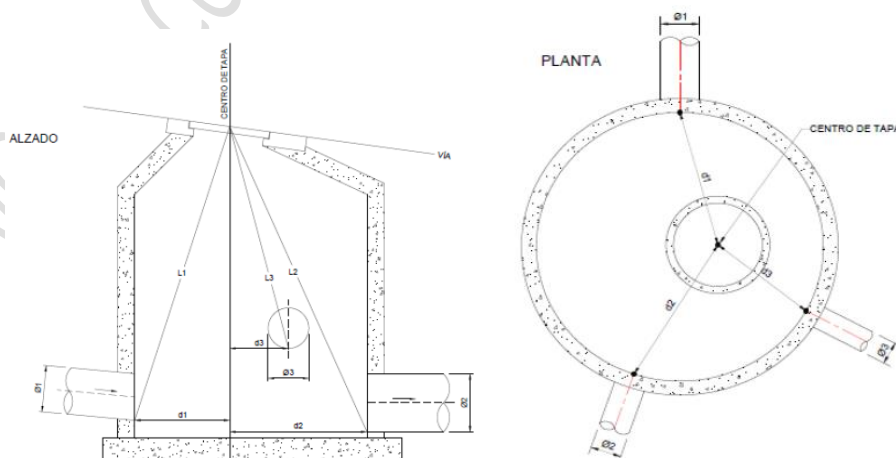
Vista en altura y planta del levantamiento de cámaras excéntricas
